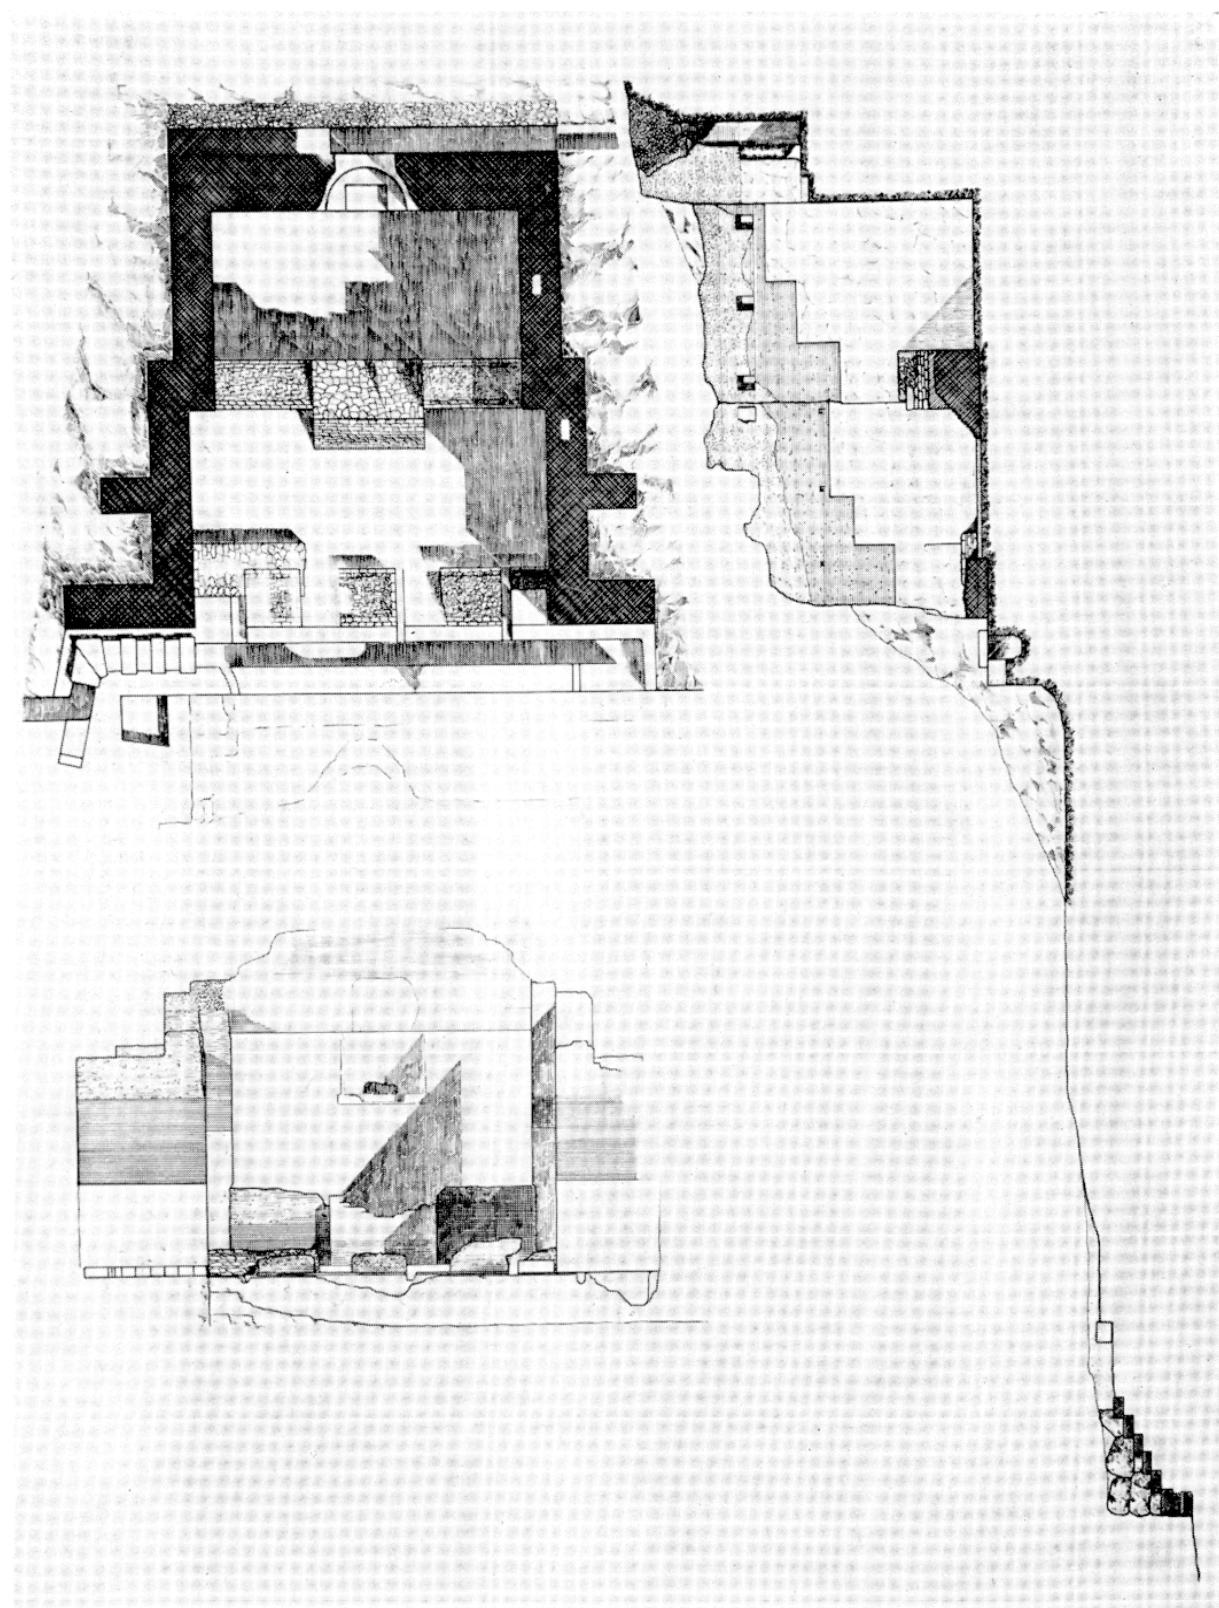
Le nymphaeum : plan, façade et coupe.
